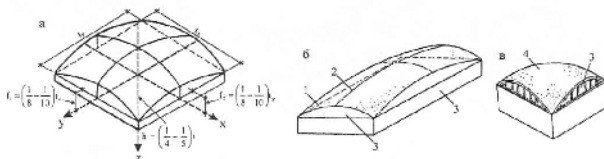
Тонкостенные оболочки положительной Гауссовой кривизны: а, б – оболочки переноса на прямоугольном и квадратном плане; в – сферическая парусная оболочка покрытия на треугольном плане; 1 и 2 – образующая и направляющая оболочки переноса; 3 – диафрагма жесткости; 4 – оболочка
